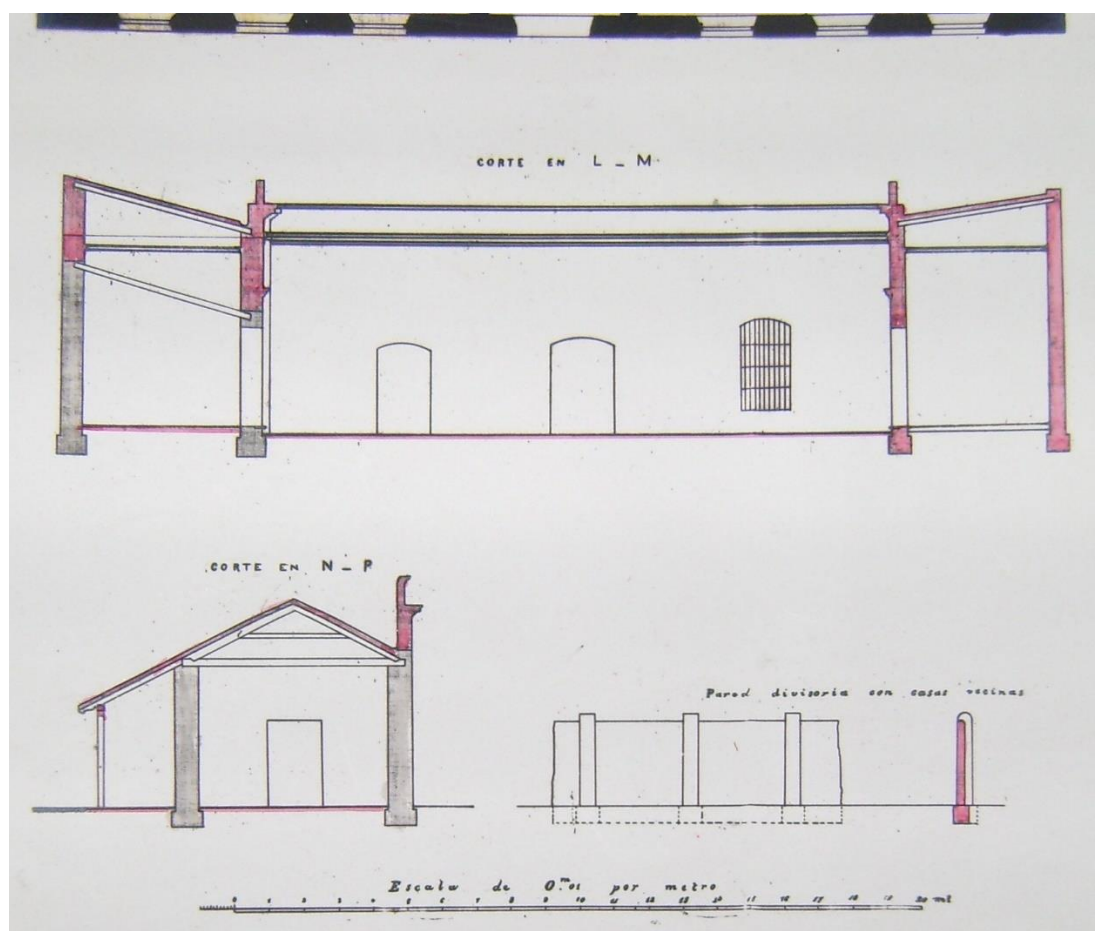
Detalle Cortes – Vistas plano nº 5 DGA
